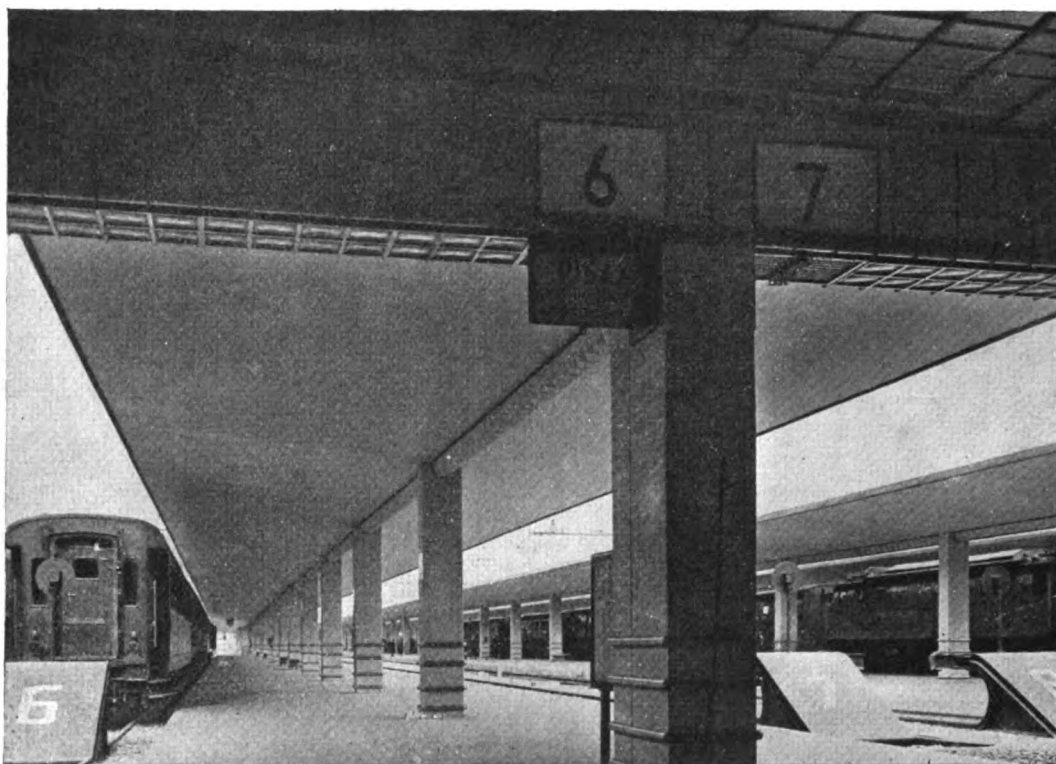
Fuga di pensiline viste dalla galleria di testa.
